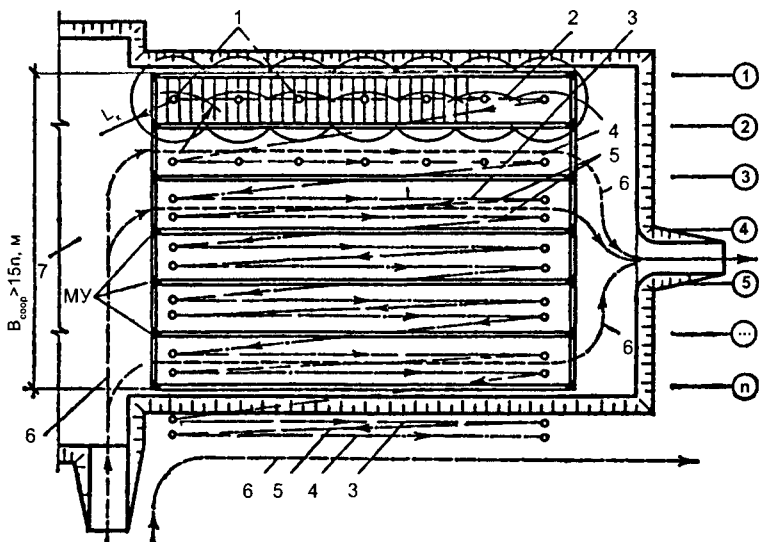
Принципиальная схема монтажа горизонтального отстойника:
